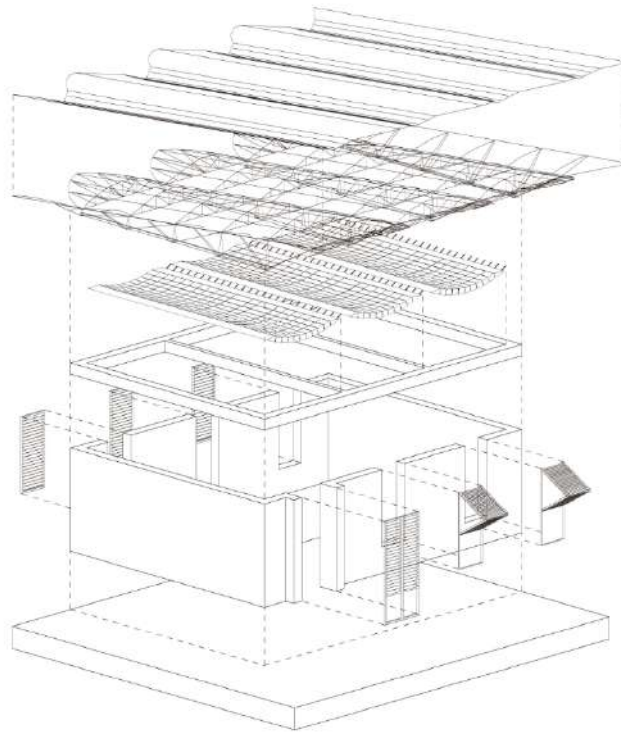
Planta Arquitectónica de la escuela secundaria de Gando
